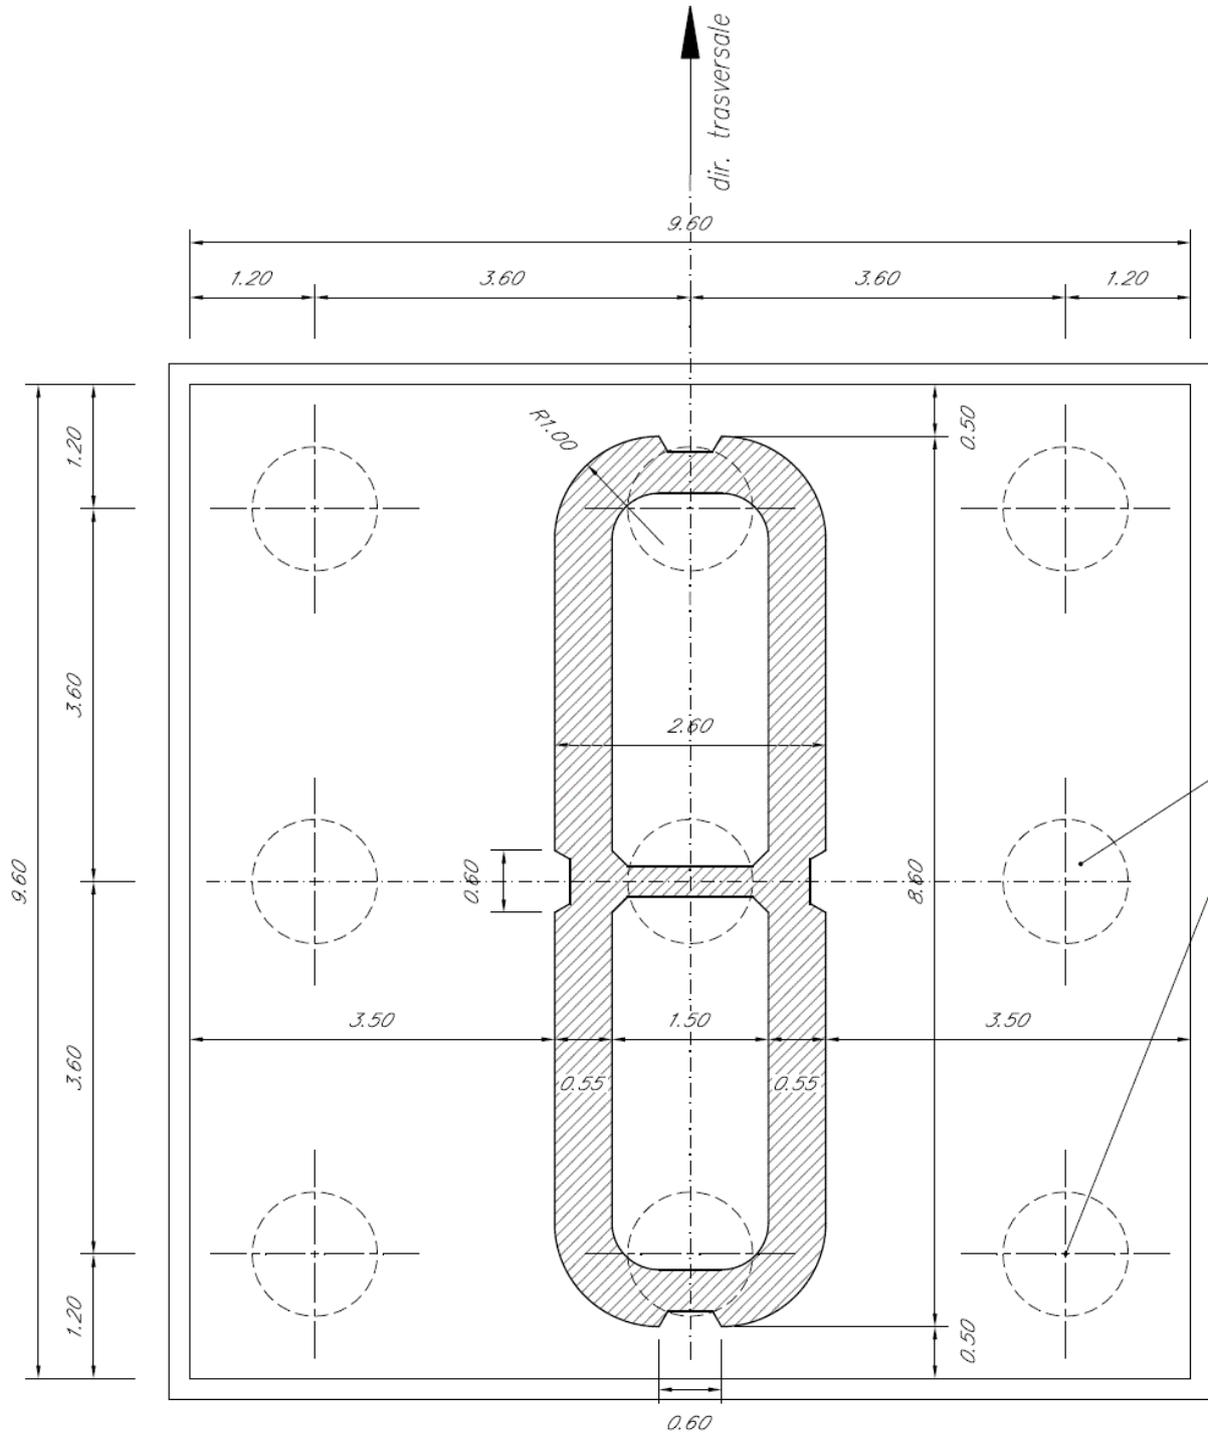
Plinto di fondazione e pali, vista in pianta - Sezione del fusto pila [m]
